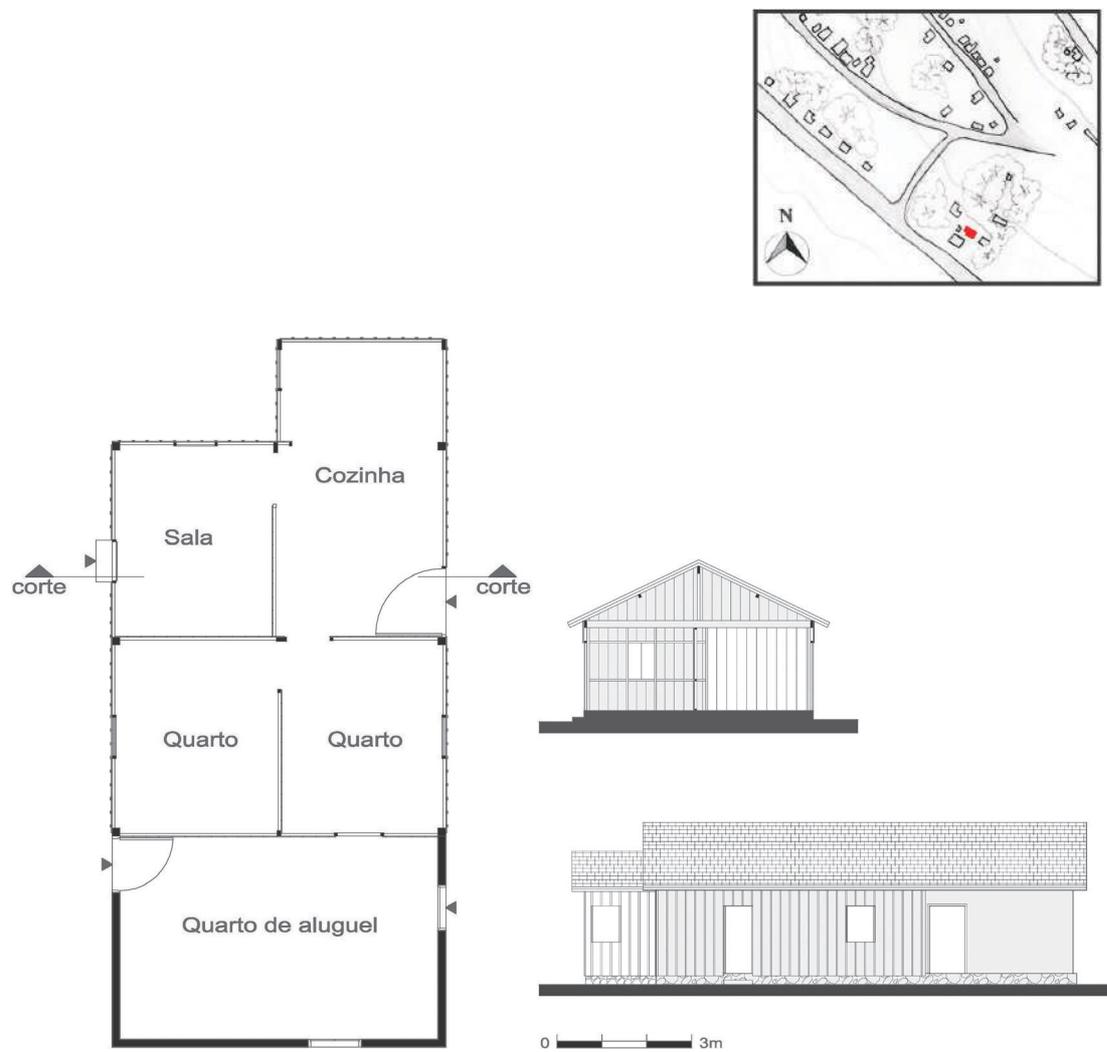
Planta baixa e cortes do Barraco da Gegê.
